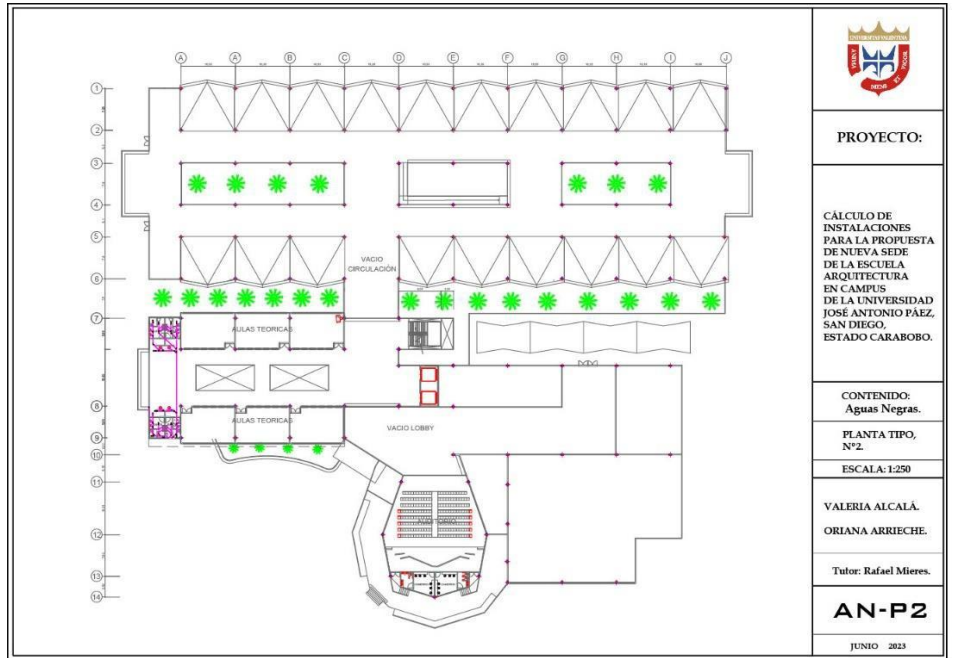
Distribución de aguas negras planteadas, planta tipo Numero 2.
